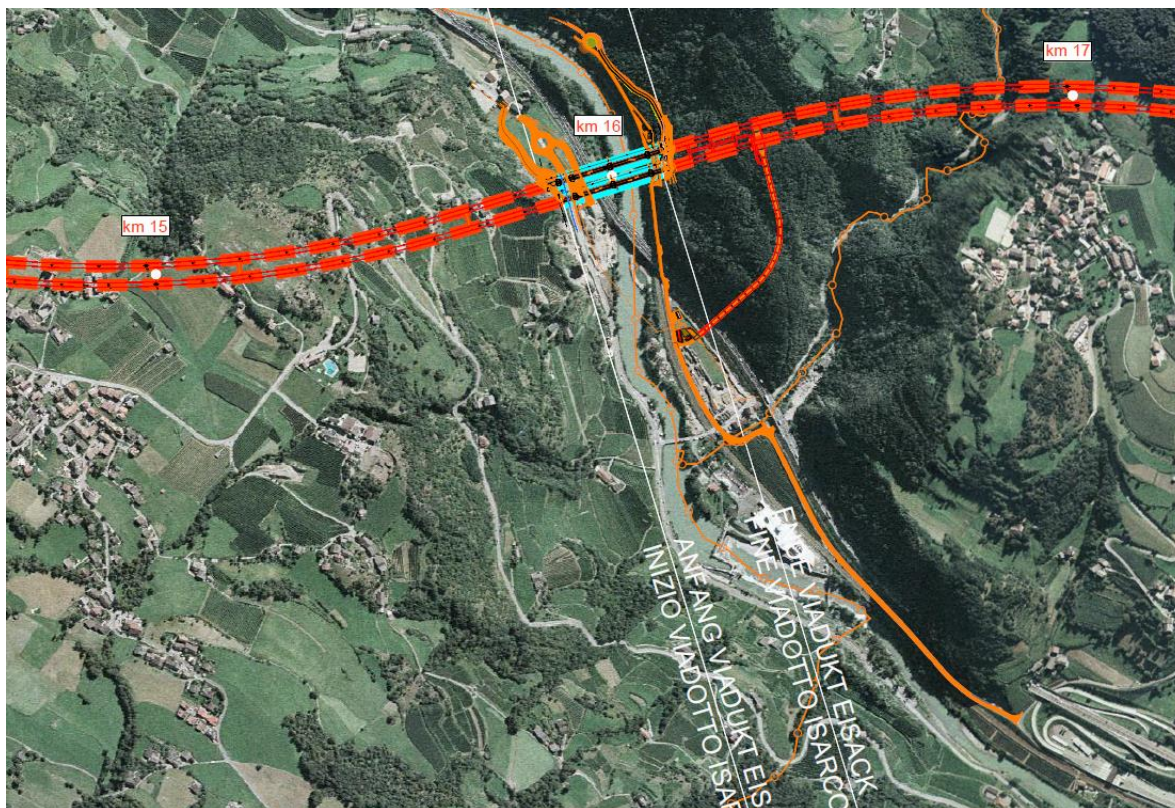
Finestra Funes –Stralcio planimetria di inquadramento
